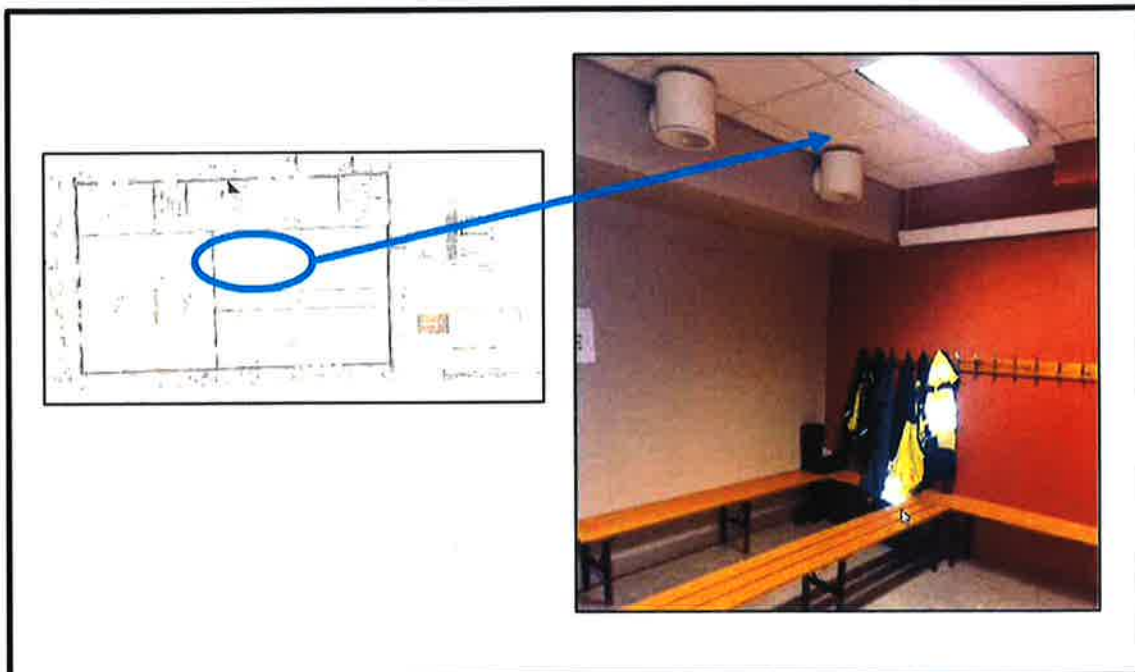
Tilstand betongdekker over kjelleretg, bassengdel
